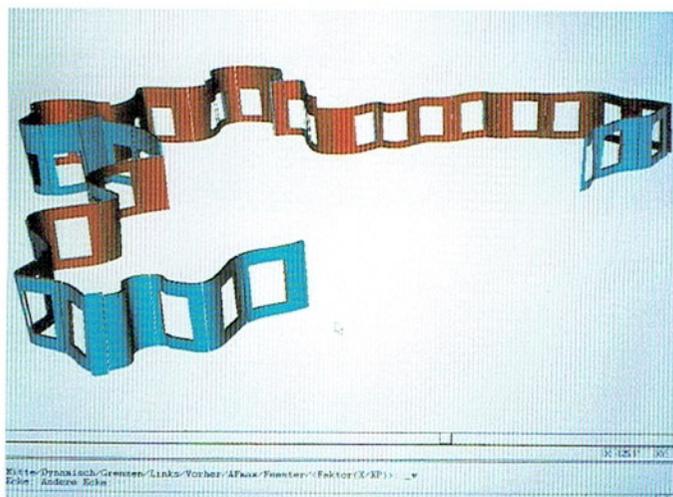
Abwicklung einer Geschoßscheibe (Haus B)
